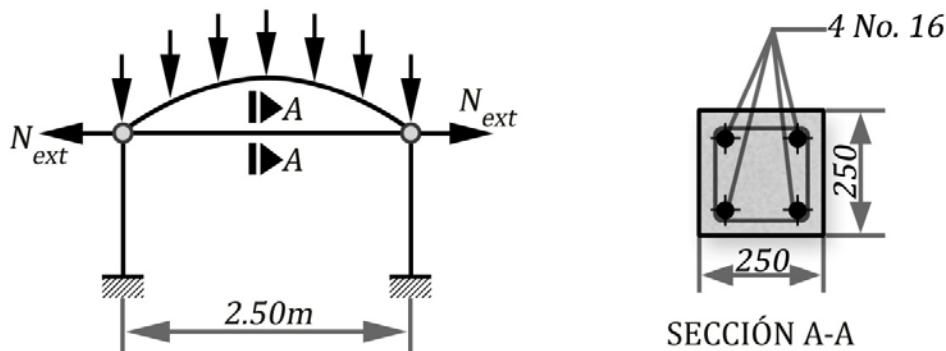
Tensor de hormigón armado para tomar los empujes del arco.
